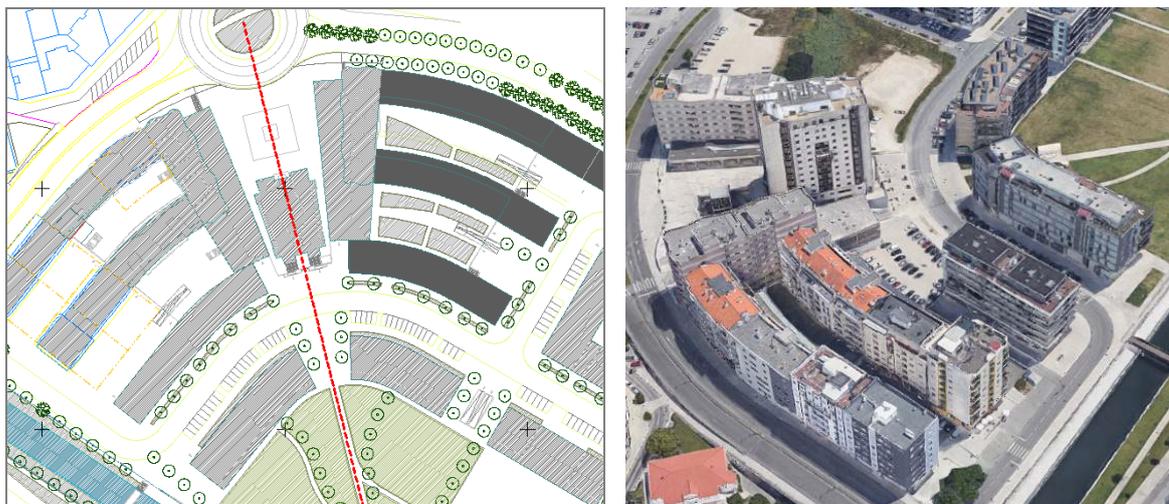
Plano anterior e situação atual; Fonte: /www.google.pt/maps
